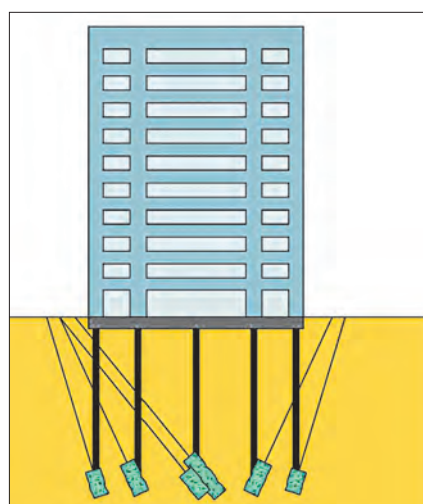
CONSOLIDACIÓN DE LA PUNTA DE PILOTES MEDIANTE JET-GROUTING.
